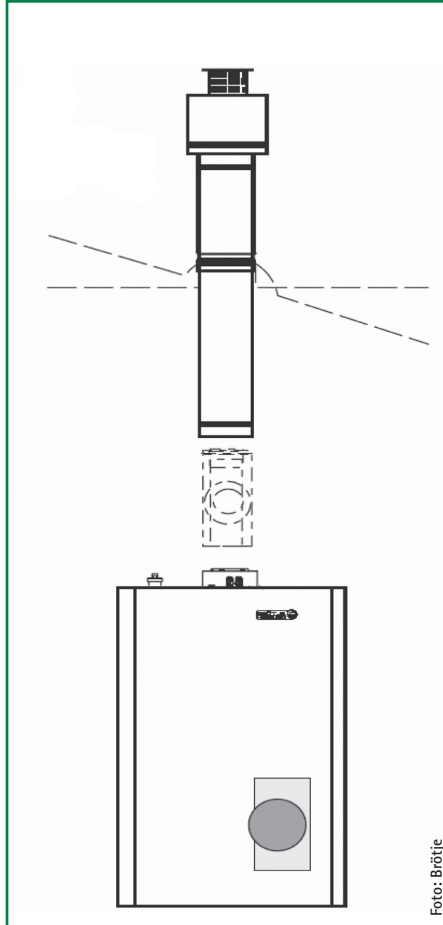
Gas-Brennwertheizkessel als Dachheizzentrale mit Abgasleitung als Dachdurchführung
